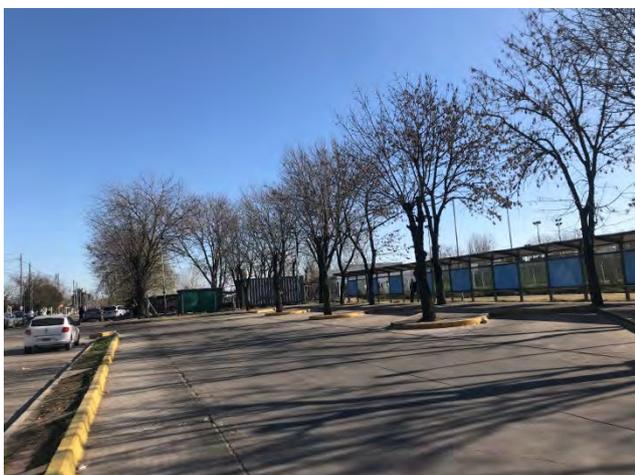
Playón para colectivos Est. Maquinista Savio Beliera al100
